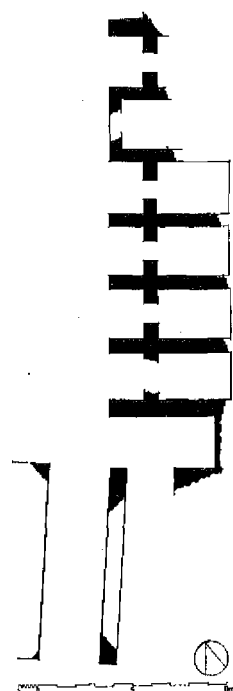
Kairo, Wakālat al-Quṭn, Grundriß der Südostecke — Erdgeschoß
